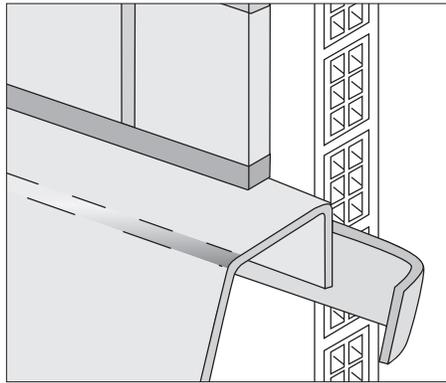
Amortización de la vibración de la tina de baño colocando un aislante en su unión con la pared.
